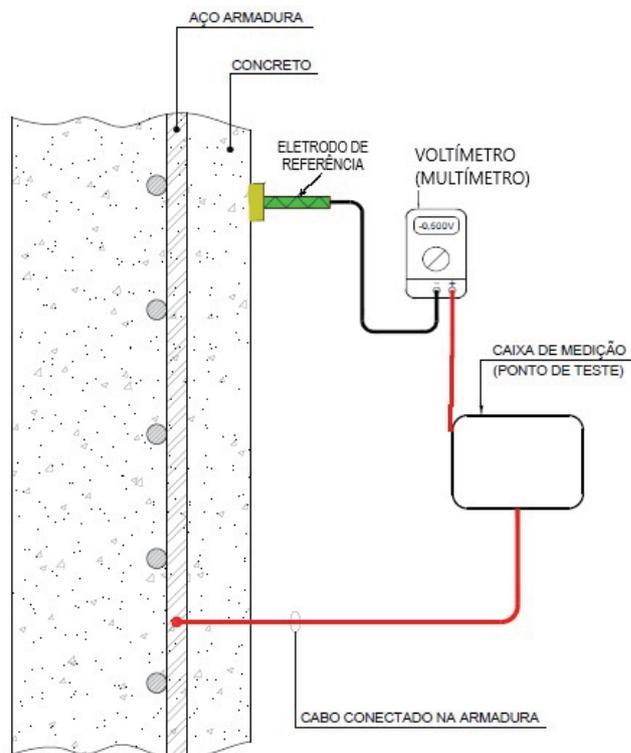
Desenho esquemático de um ponto de teste em estrutura de concreto, para medição do potencial de corrosão da armadura.
